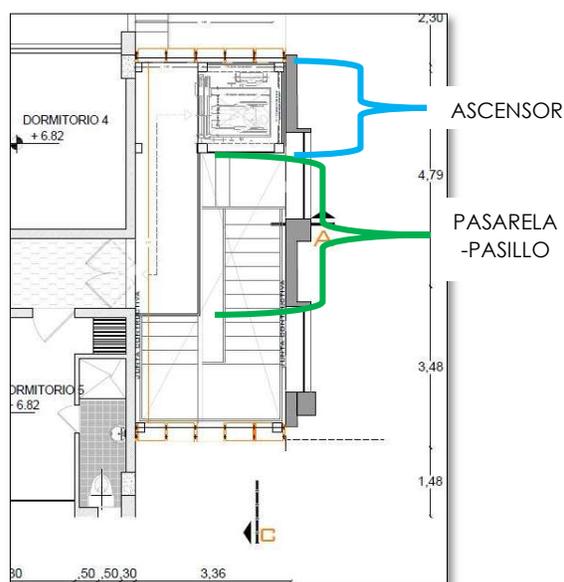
Propuesta, segundo piso de nuevo hall.
